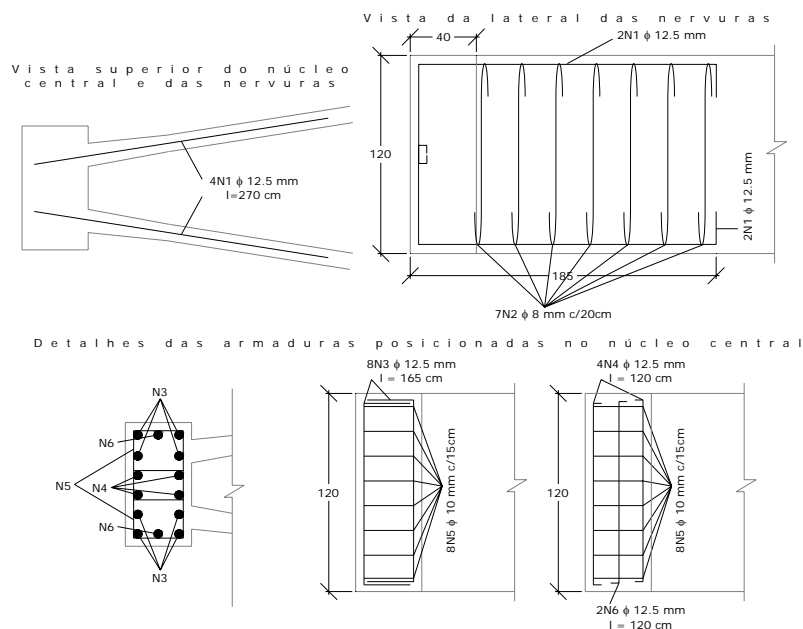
Projeto e detalhamento das armaduras do flutuador.
